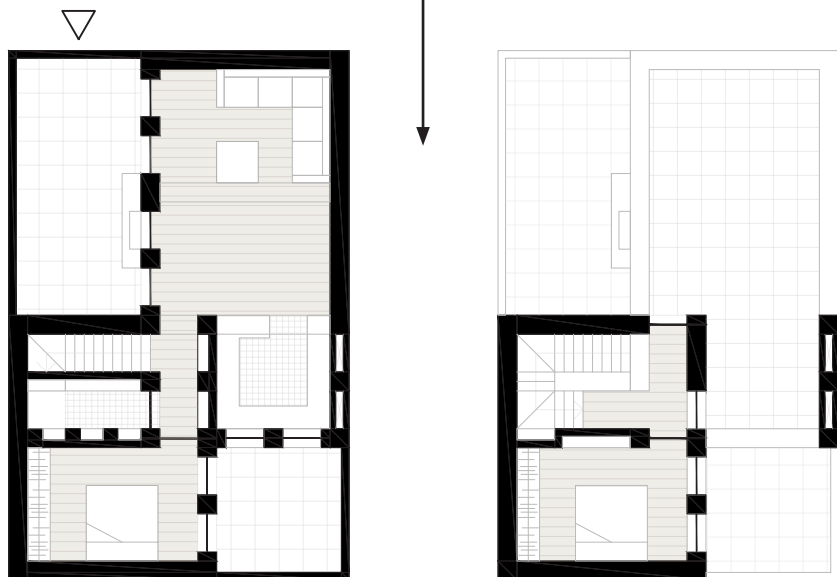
Plantas módulo base na primeira fase evolutiva 1:200
